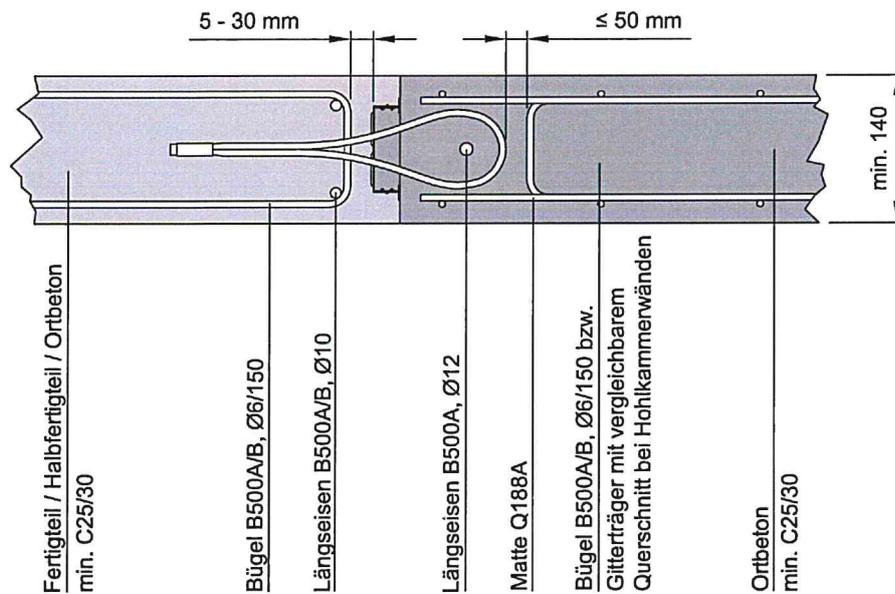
Regel-Anschlussdetail Querschnitt mit Ortbetonergänzung, Bewehrung
